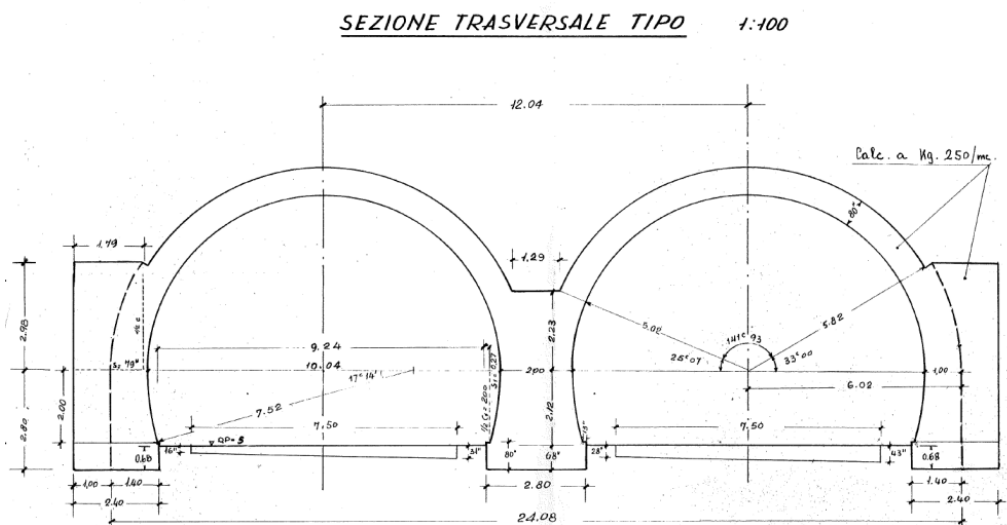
Sezione trasversale tipo del tratto naturale – galleria Ragnaia I canna destra e sinistra.
